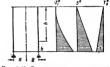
Внутренние усилия в цилиидрической оболочке от ветровой изгрузки.
